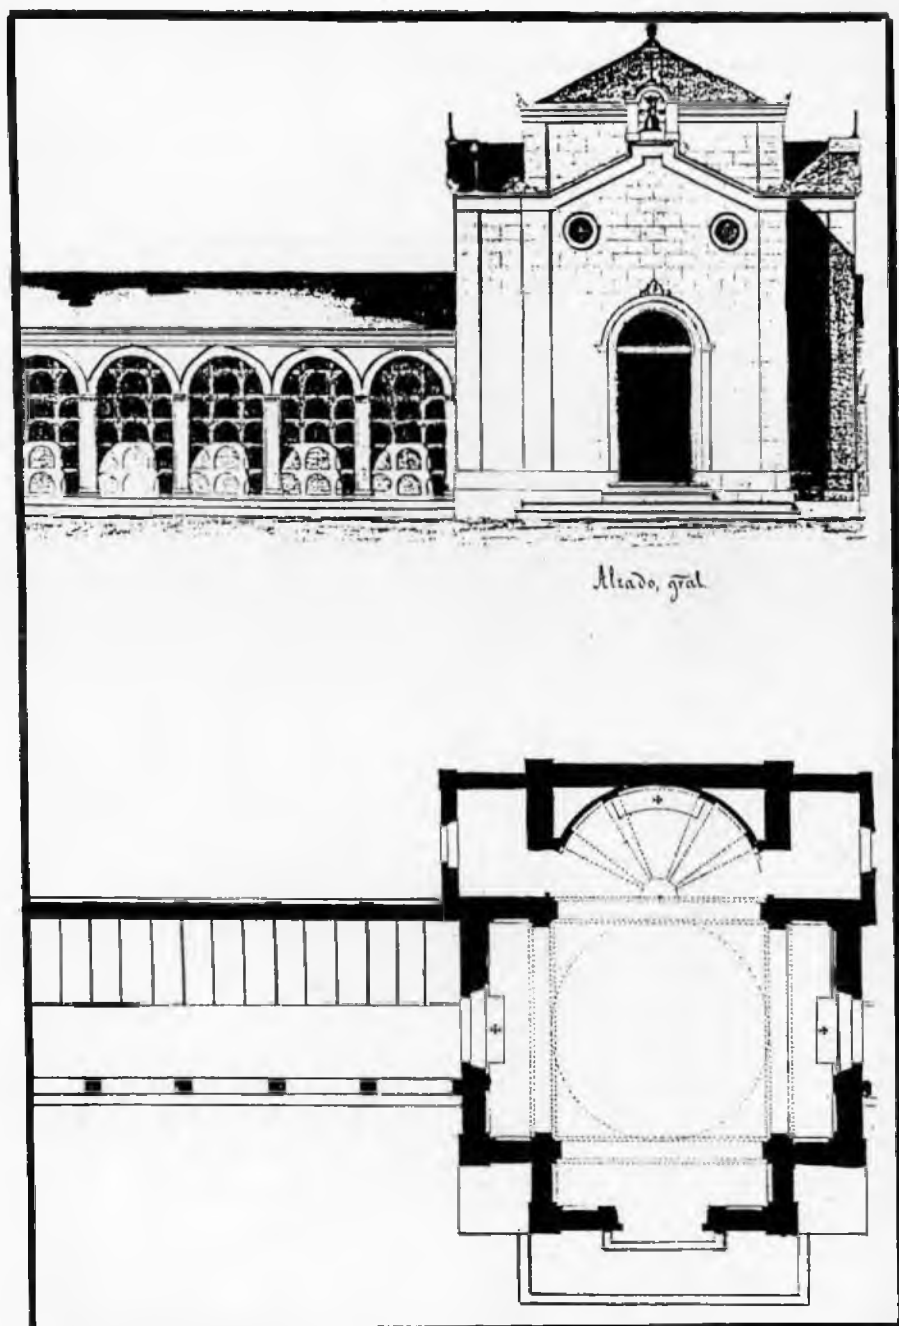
Planta y alzado de la capilla y galerías propuestas en la ampliación diseñada en 1855.
